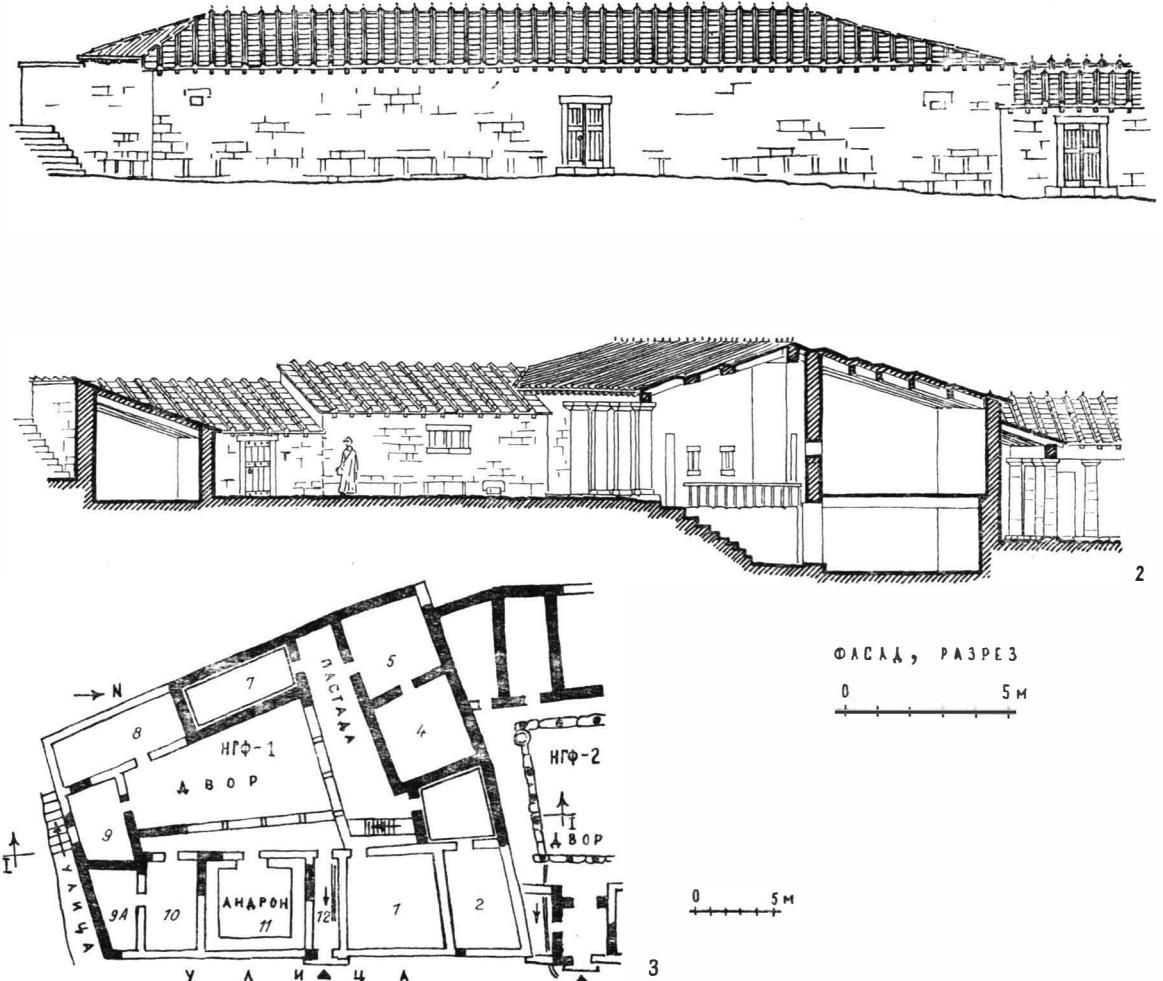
Участок НГФ. Дом НГФ-1. Реконструкция: 1, восточный фасад; 2, продольный разрез; 3, план II строительного периода.
